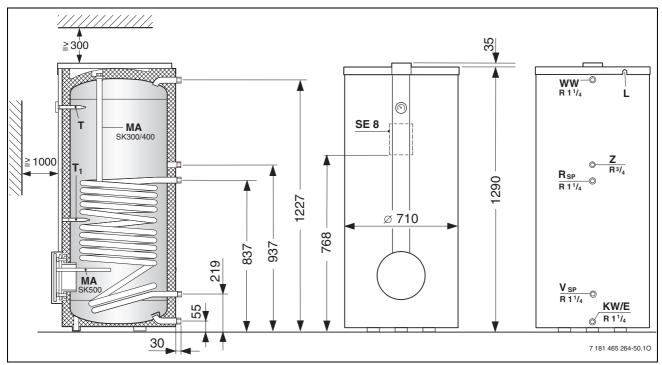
Bau- und Anschlussmaße SK 300-3 ZB
